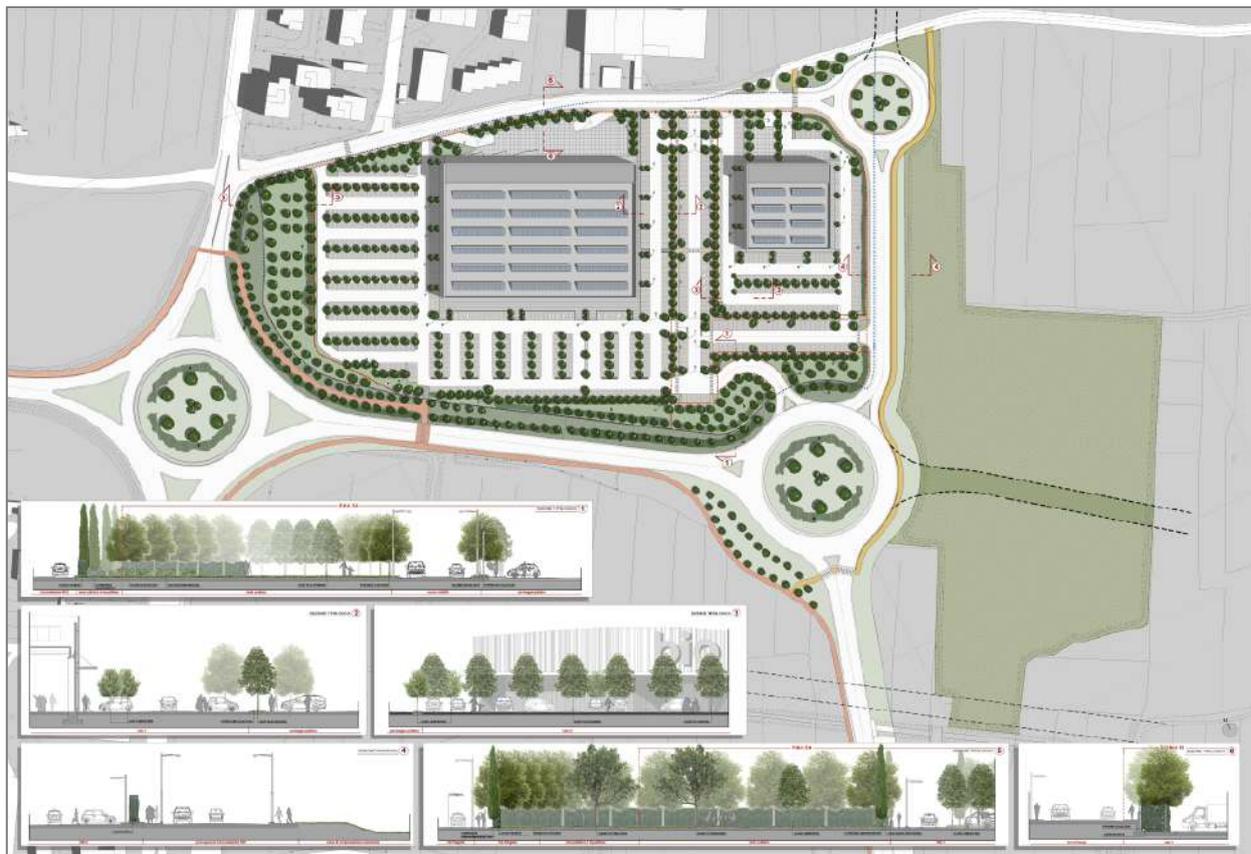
Tav. D1 Aspetti paesaggistici del sistema a verde (Fonte: Piano Attuativo PMU "SA_1-Palagetta")
